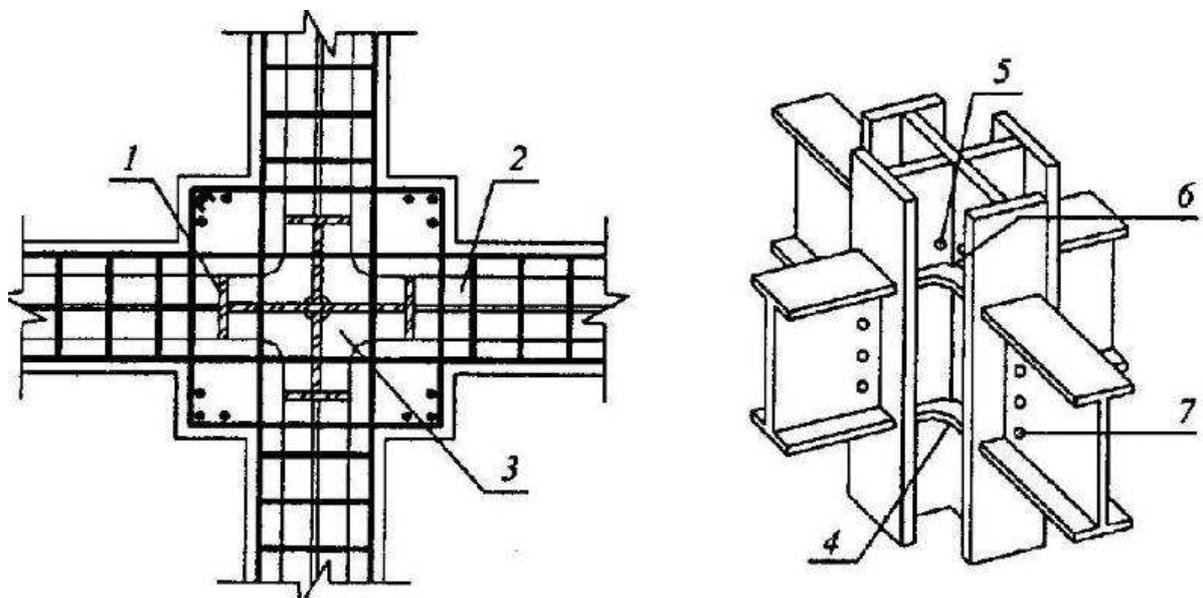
Монтажный узел соединения железобетонной колонны с обычным армированием и балки с жесткой арматурой для каркаса высотного здания: 1 – стальной профиль в конструкции колонны; 2 – стальной профиль в конструкции балки; 3 – бетонное ядро; 4 – горизонтальное нижнее ребро с отверстиями для выхода воздуха при бетонировании; 5 – отверстие в профиле колонны; 6 – горизонтальное верхнее ребро с отверстиями для выхода воздуха; 7 – монтажные отверстия в конструкции балки
